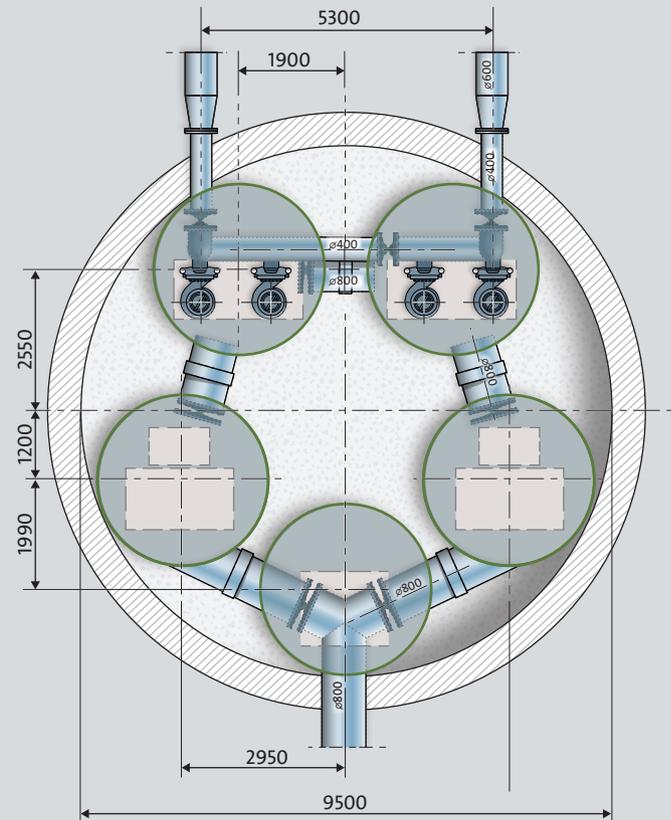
Pumpenanlage mit vier Pumpen, aufgeteilt auf zwei Tanks, sowie drei weitere Tanks zum Aufnehmen des benötigten Volumen des Sammelbrunnens
